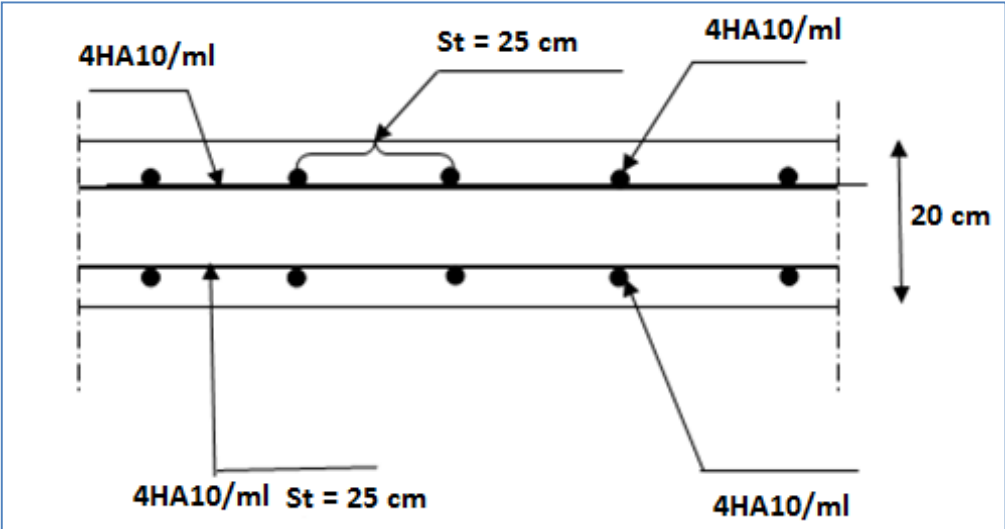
Ferrailage de la dalle pleine de la salle machine dans le sens y-y
